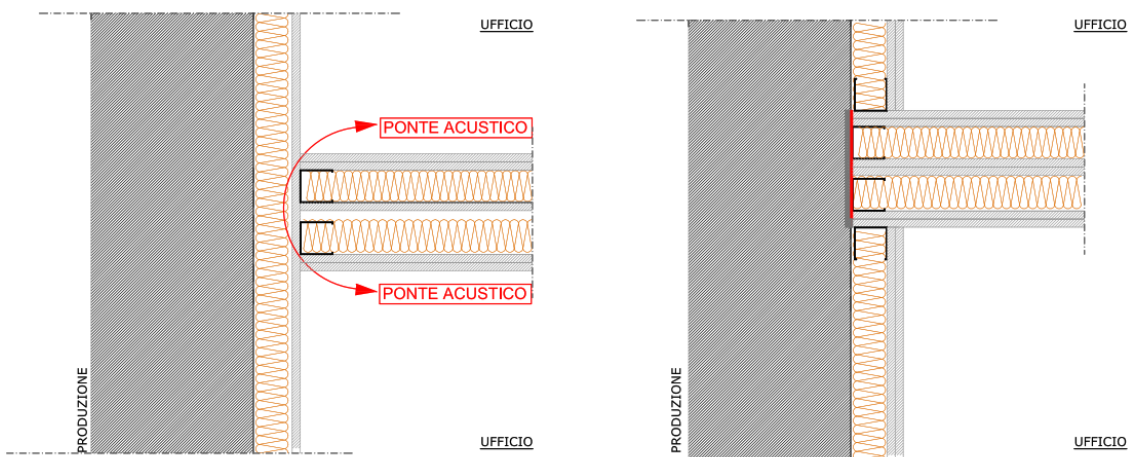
Sezione orizzontale. Trattamento del ponte acustico tra strutture verticali (parete perimetrale e parete interna)
